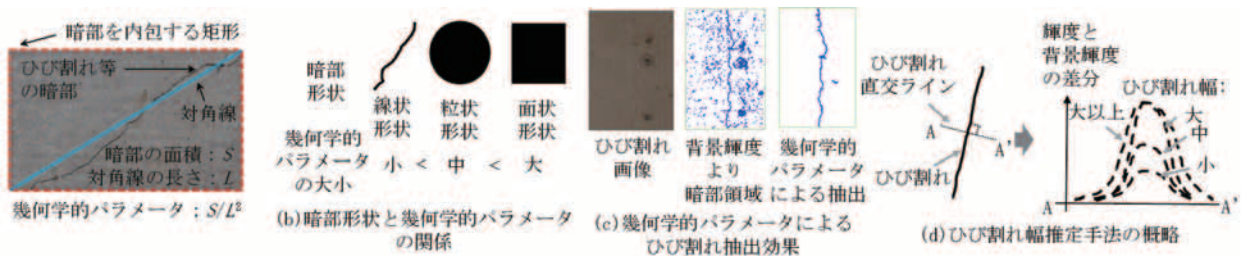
新規で提案するひび割れ抽出、幅推定手法
